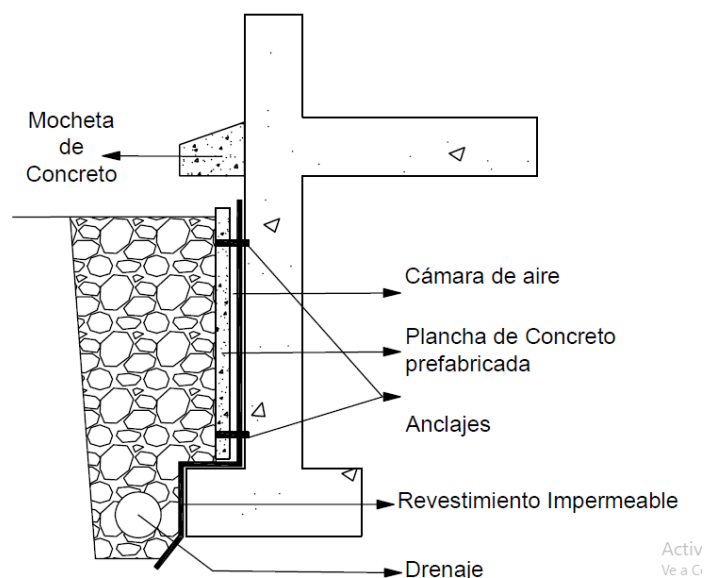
Cámara de Aire, Drenaje y Revestimiento Impermeable
